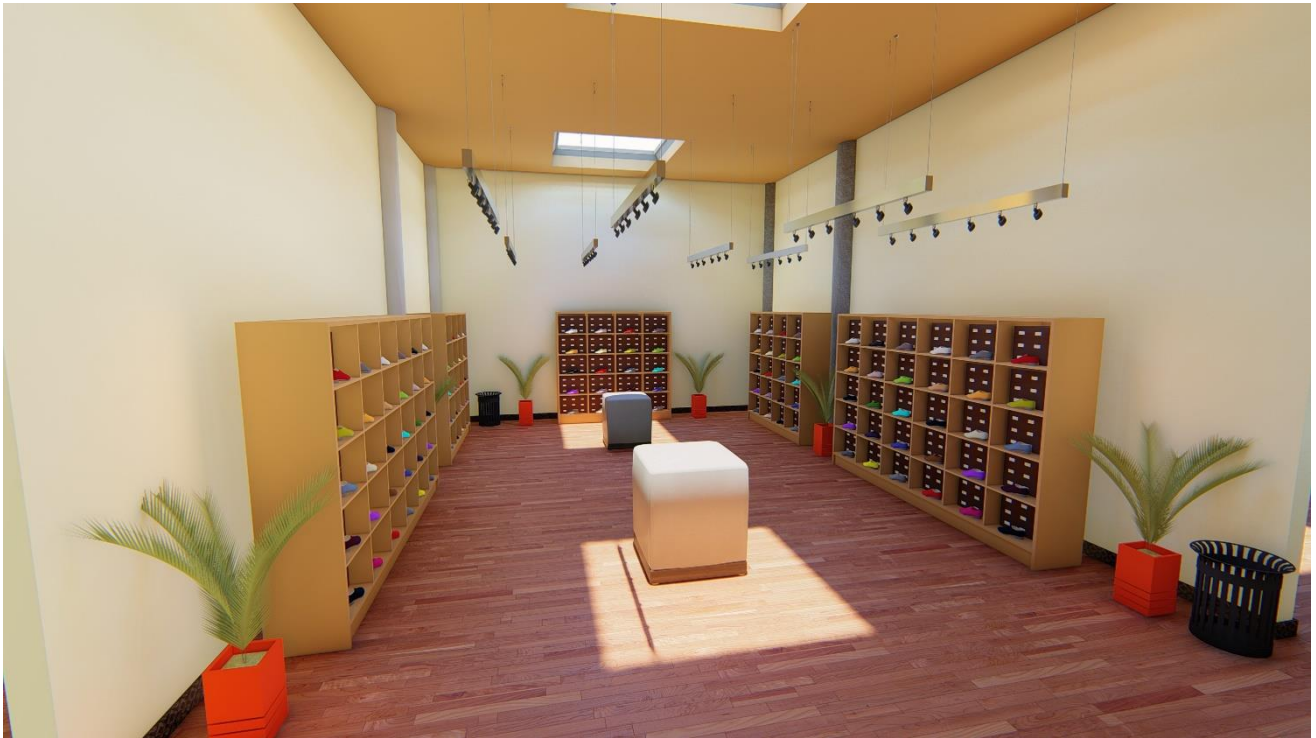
Vista de la Sala Temática de Calzado Internacional
